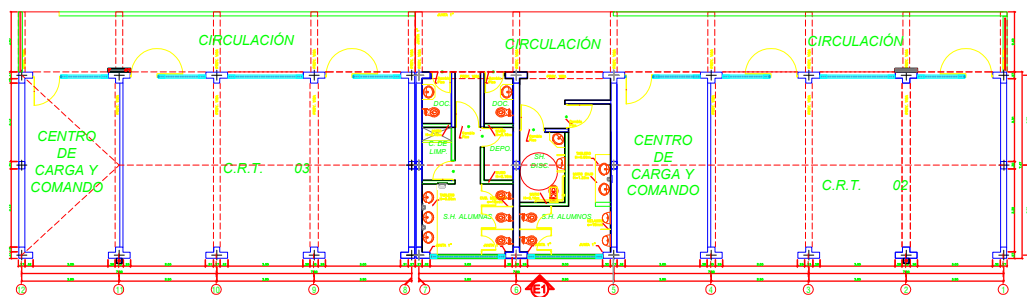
Planos Contractuales de Arquitectura- Fuente:Propia
